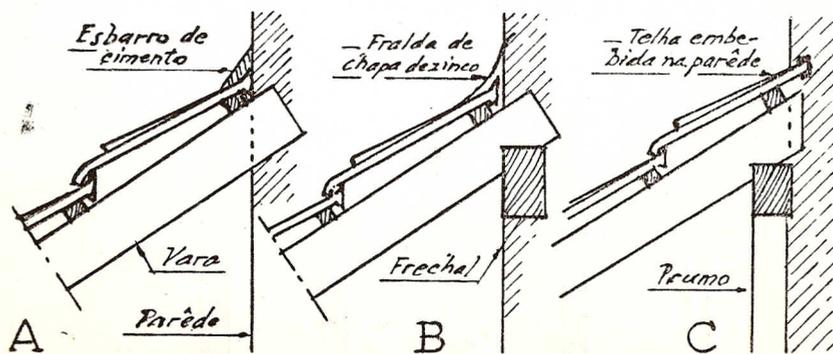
LIGAÇÕES DE COBERTURAS DE UMA ÁGUA À CONSTRUÇÃO ONDE ENCOSTAM
